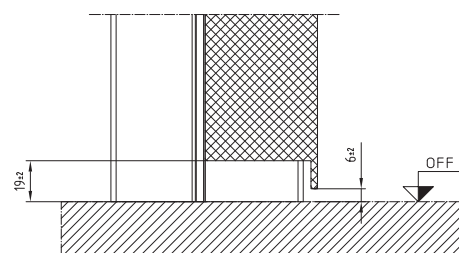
unterer Türblattabschluss, 3-seitig
